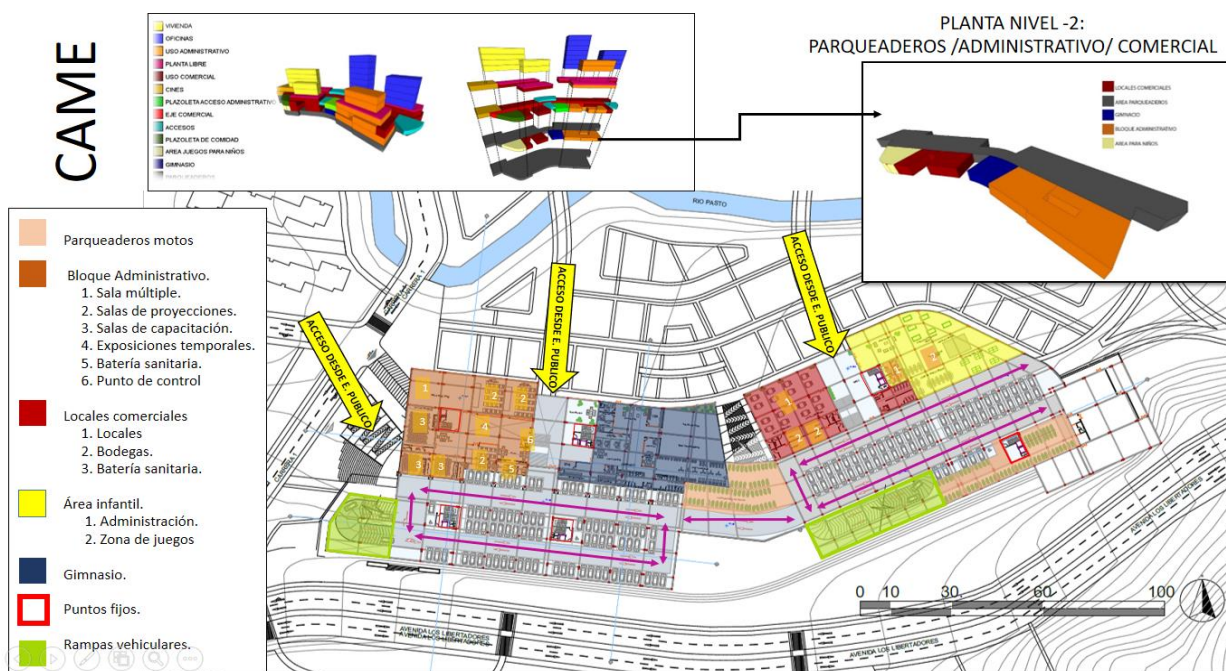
Esquema análisis planta arquitectónica nivel -2
